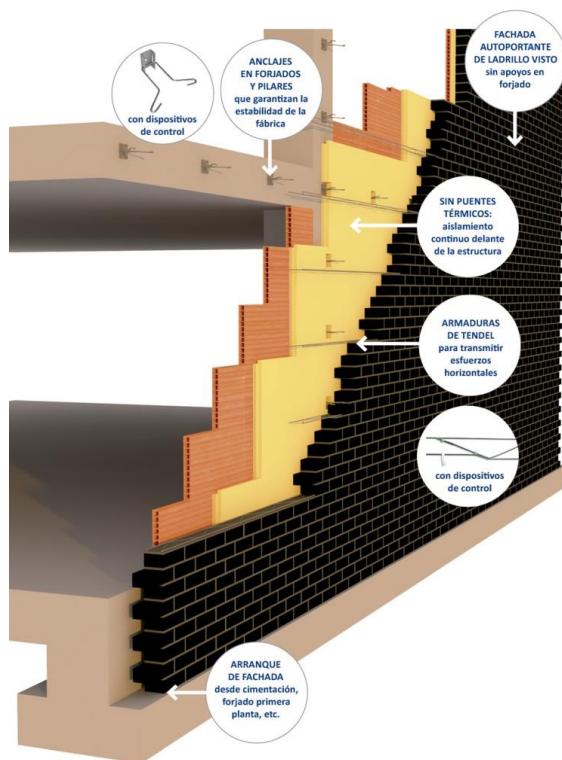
Imagen de fachada autoportante de ladrillo cara vista STRUCTURA
